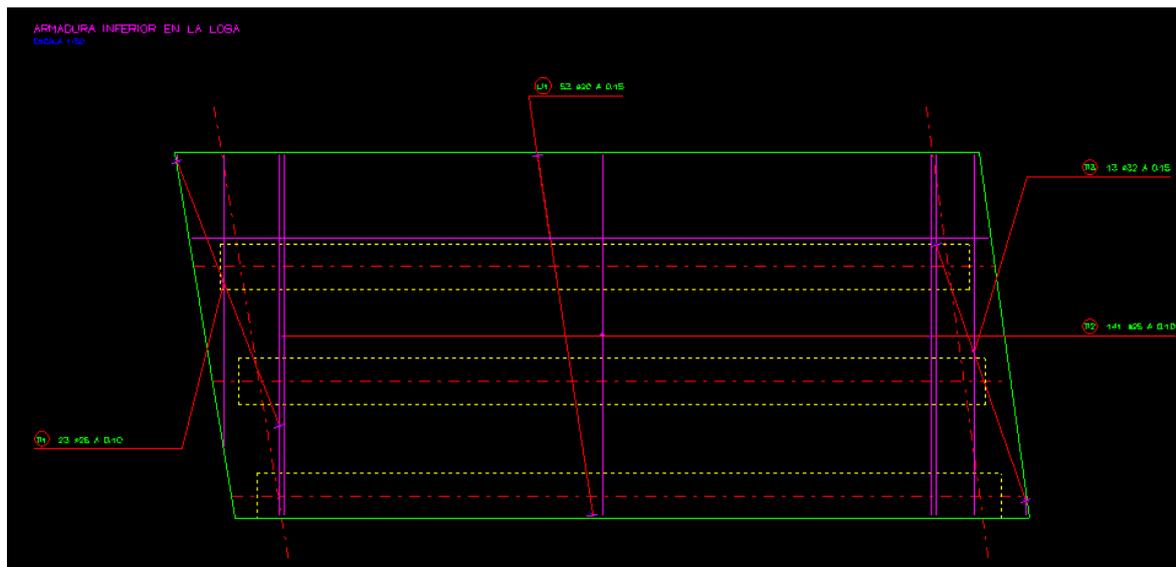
Figura *Losa. Planta. Armadura. Cara inferior.
